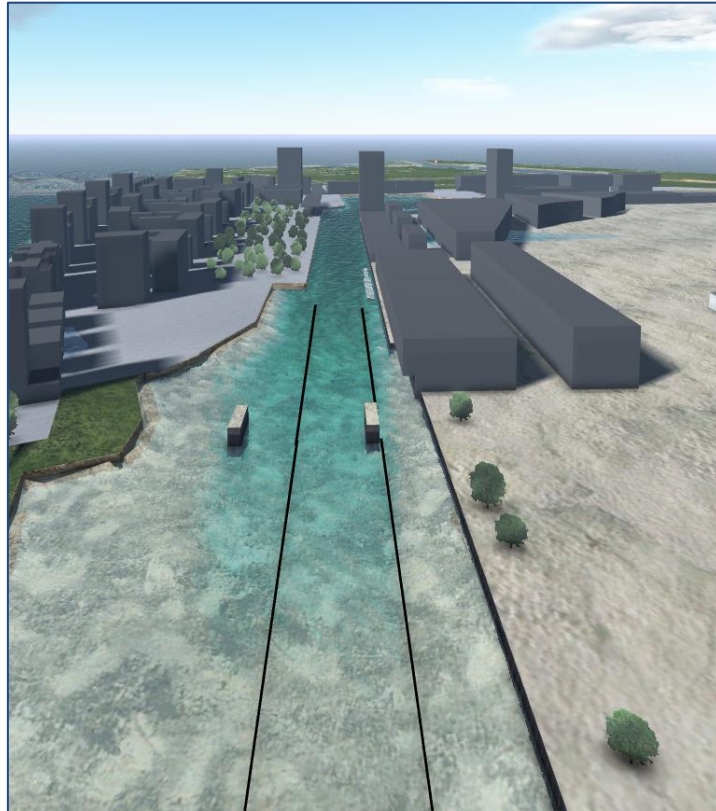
Brückenpfeiler am Westende des Moldauhafens
